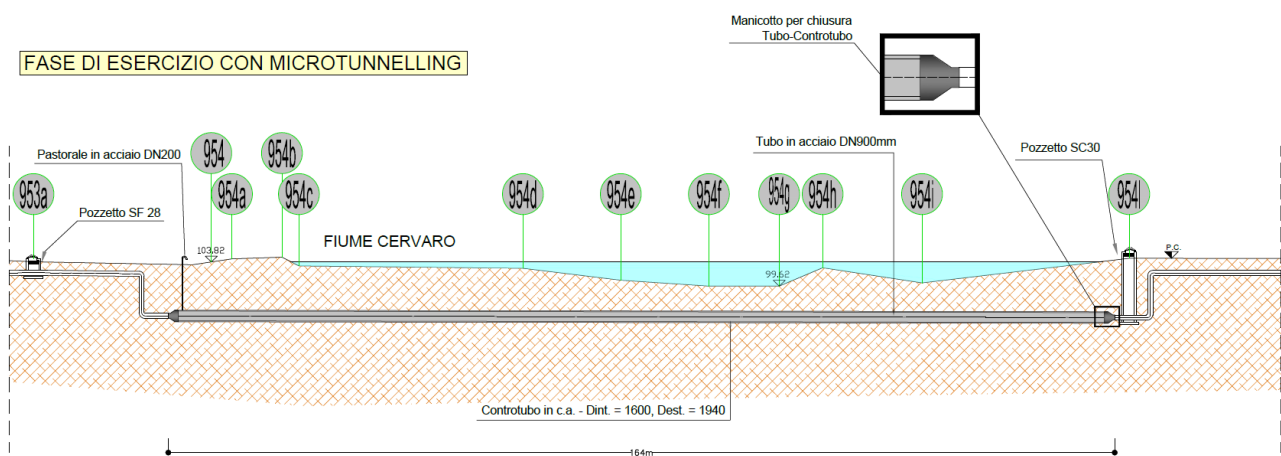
Sezione attraversamento mediante microtunneling Torrente Cervaro
